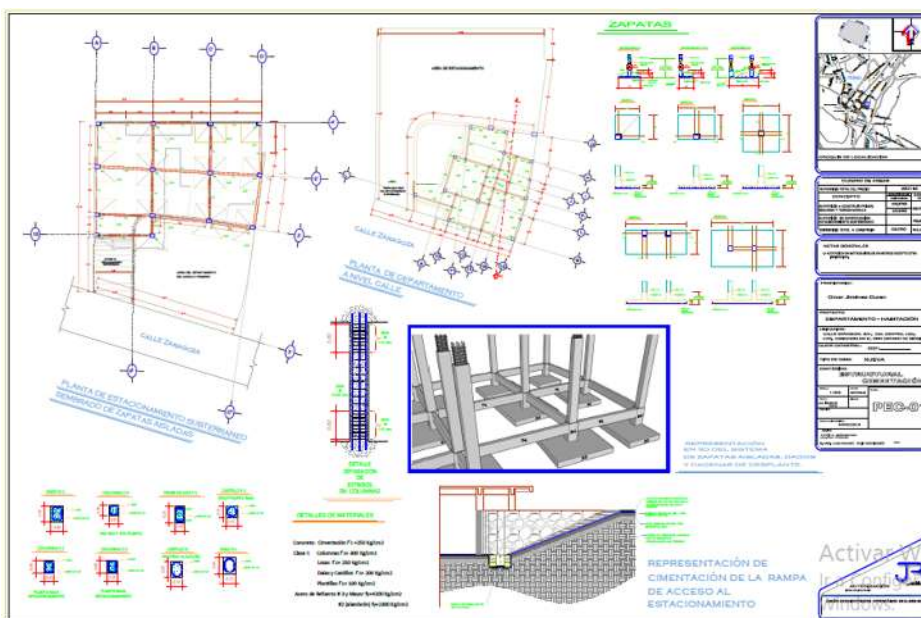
Imagen del plano de Cimentación y Desplante, donde se especifica la propuesta del tipo de cimentación, así como la simbología de ello, las plantas que conforman la cimentación, tanto en el estacionamiento subterráneo, como del primer módulo de los departamentos. La propuesta de columnas por utilizar y su configuración de armado, así como el corte de la rampa de acceso, de la calle al estacionamiento y el detalle en 3D de las columnas, dalas de desplante como las zapatas intermedias y esquineras.
